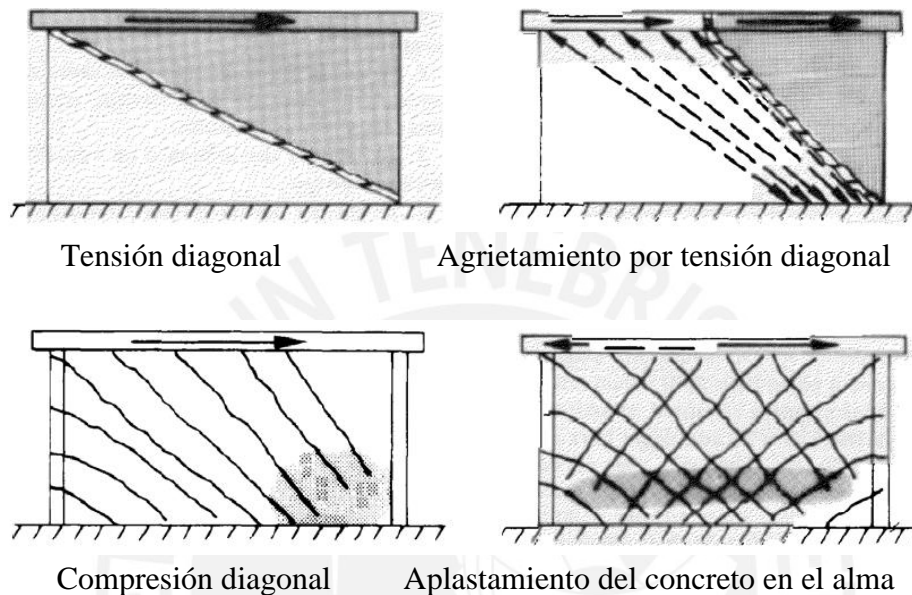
Modos de falla en muros bajos (Paulay et al., 1982).
